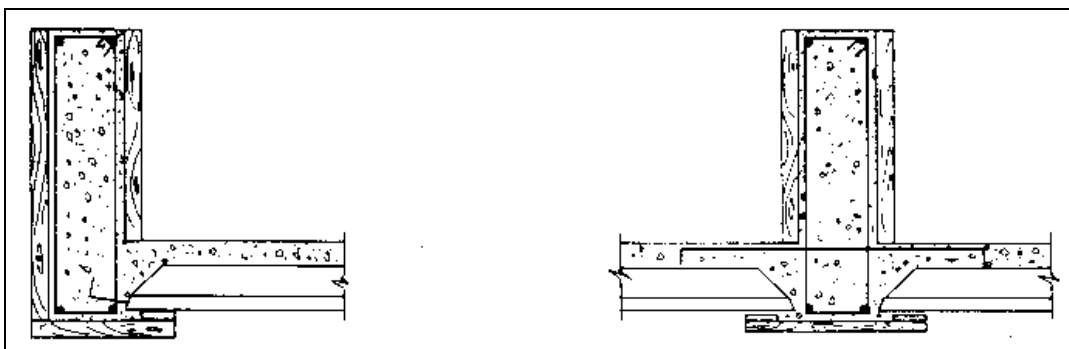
Lajes sobre vigas invertidas (SOUZA & CUNHA, 1994).
